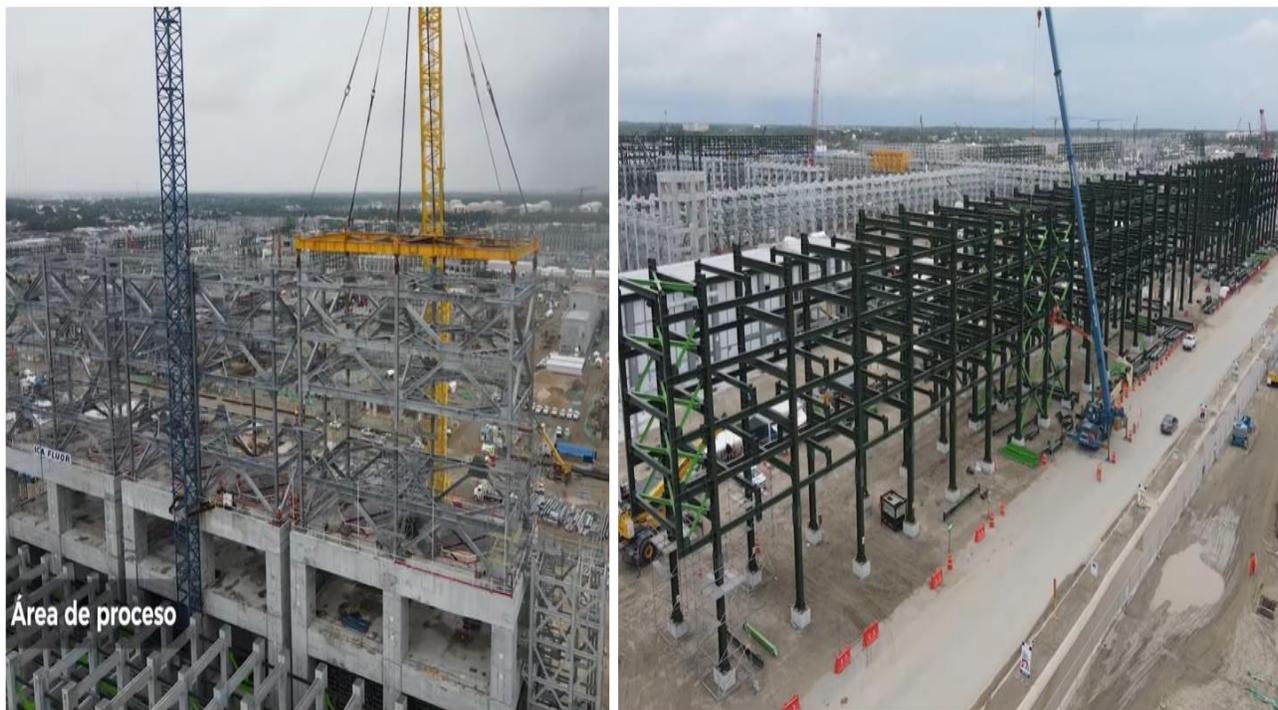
Refinería de Dos Bocas en construcción. (SENER, 2021).
